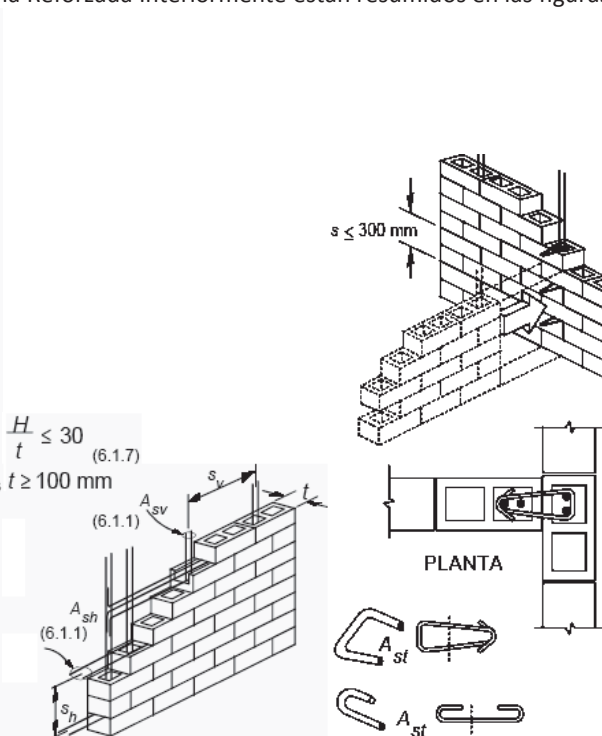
CONECTORES ENTRE MUROS SIN TRASLAPE DE PIEZAS
